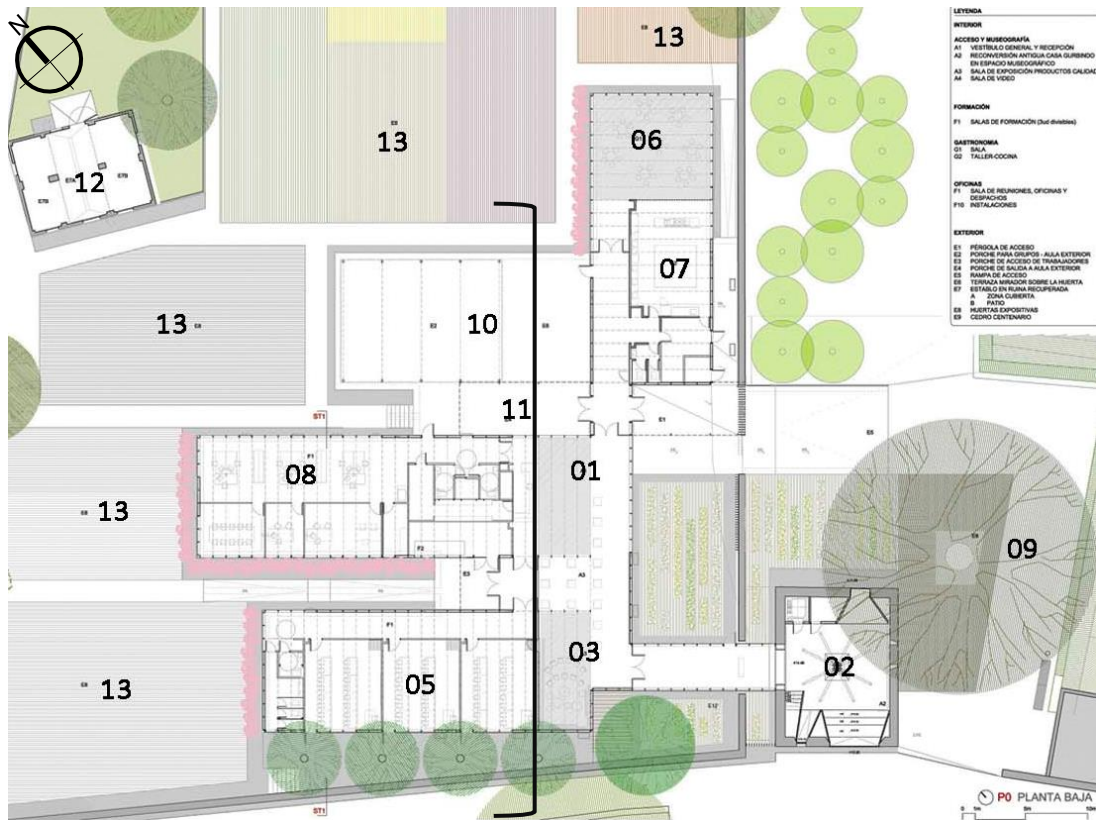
Planta baja del proyecto. Fuente: archdaily.pe (2013)
